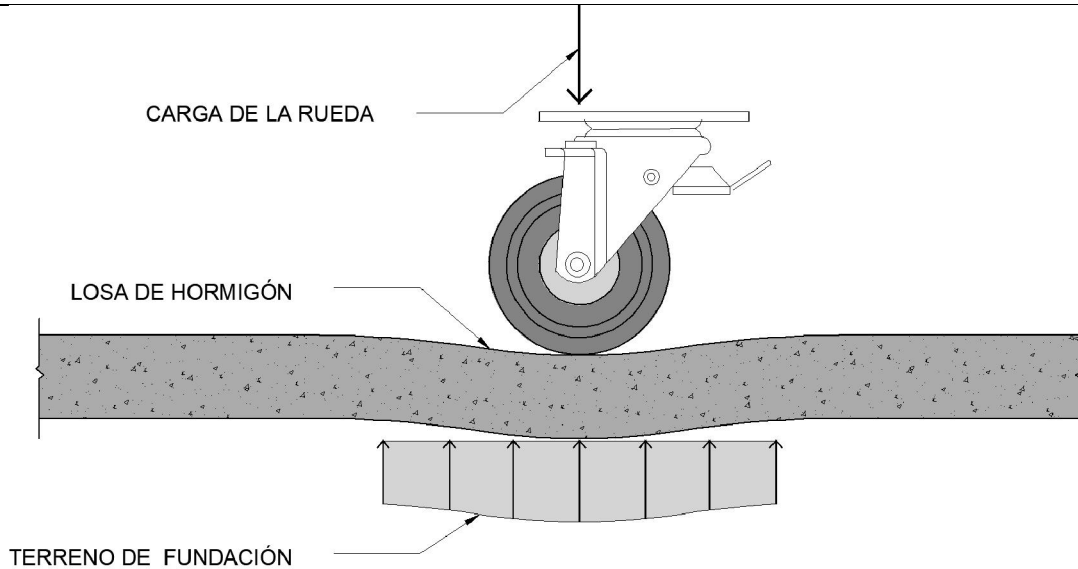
Transferencia de carga de una rueda en una estructura de pavimento rígido
